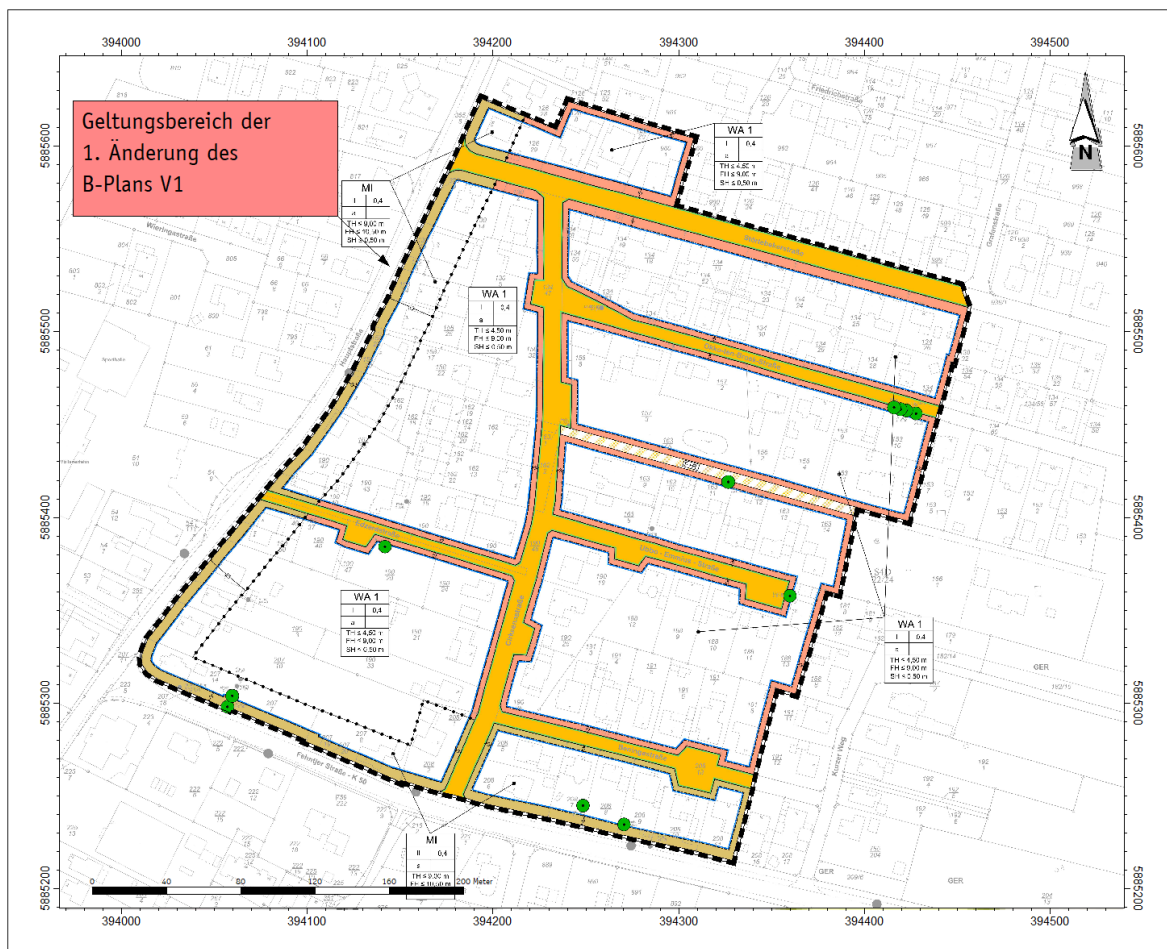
Lageplan mit dem Geltungsbereich der ersten Änderung des Bebauungsplans Nr. V1 der Gemeinde Westoverledingen (hinterlegter Plan, Quelle: [8]).
